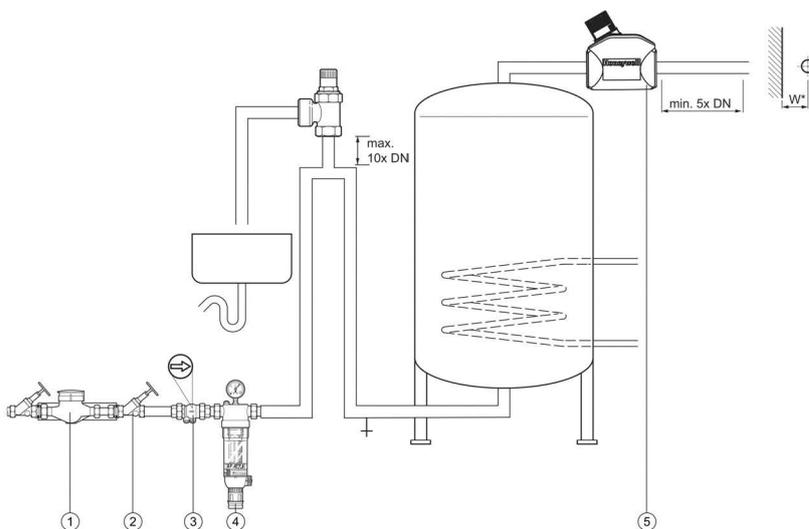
Beispiel für den standardmäßigen Einbau für Druckminderer
